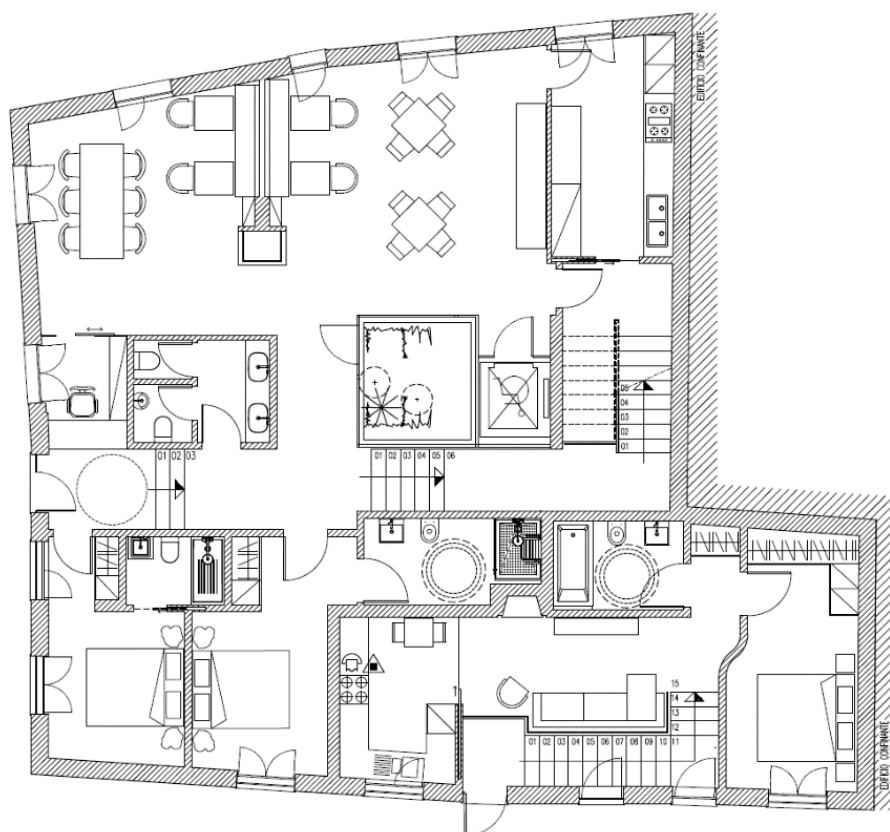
Planta de equipamento para o piso térreo. Escala 1/100.
